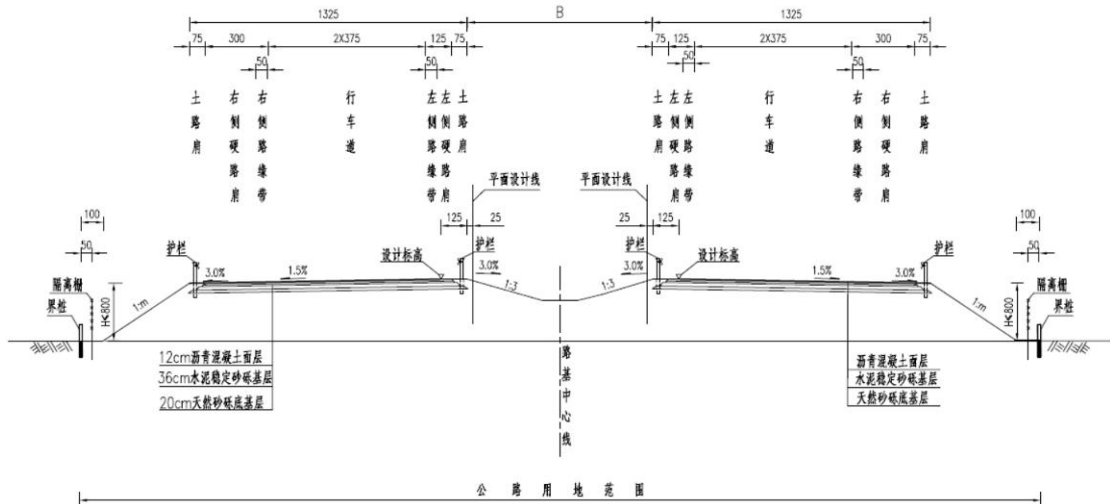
13.25m 宽分离式路基标准横断面图
